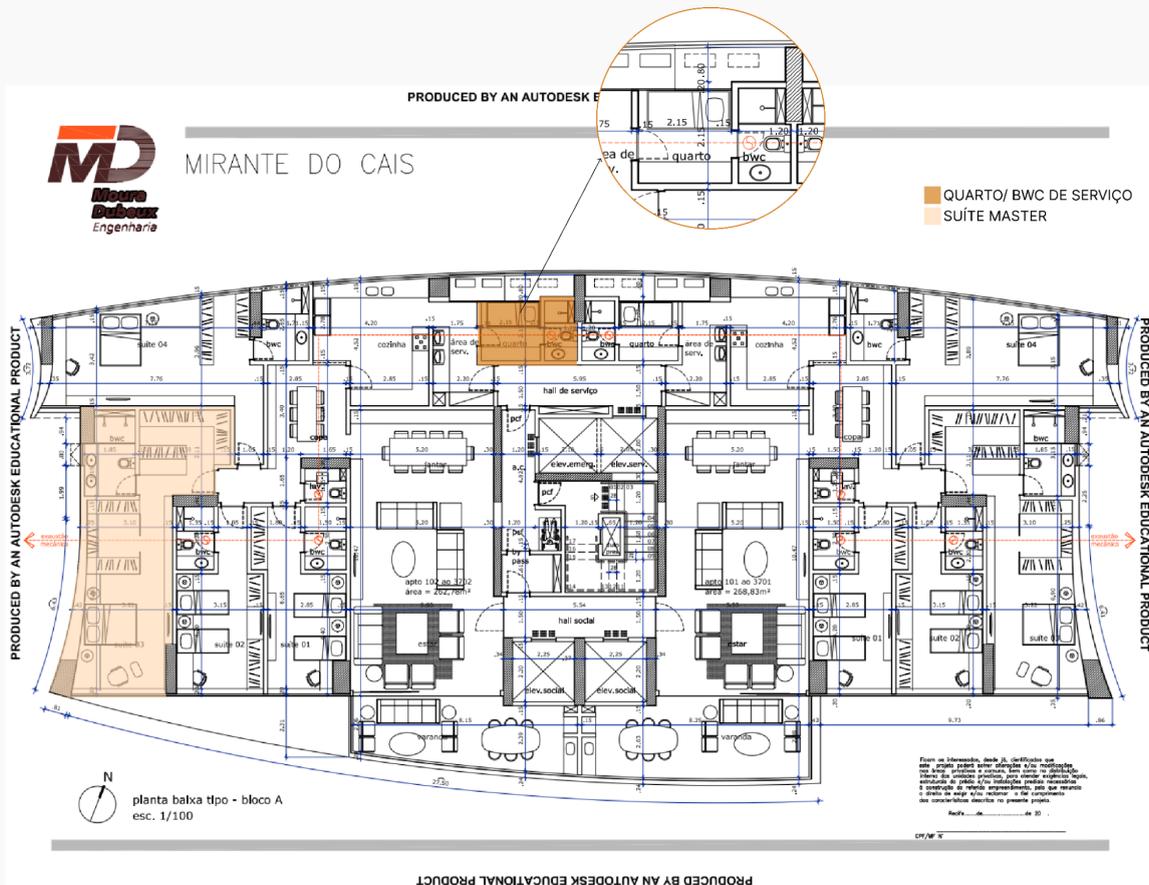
Planta Baixa Edifício Mirante do Cais (torre norte).
